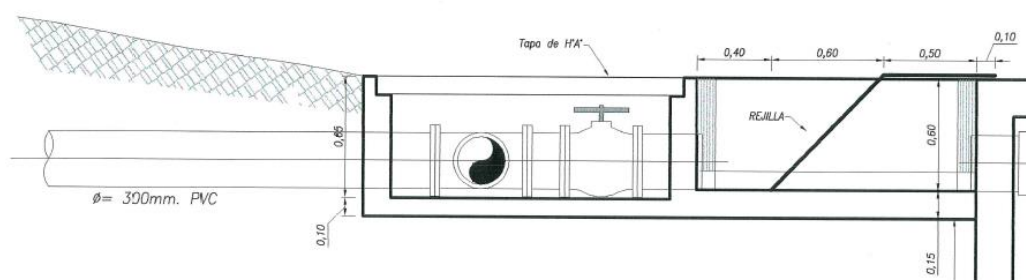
Vista en corte del pozo de revisión y canal de ingreso con rejillas
